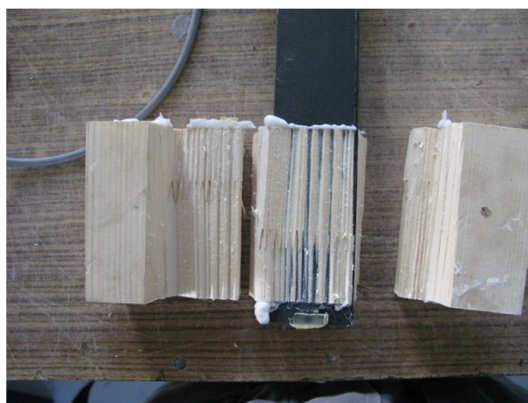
Zkušební těleso porušené Pull-out zkouškou
